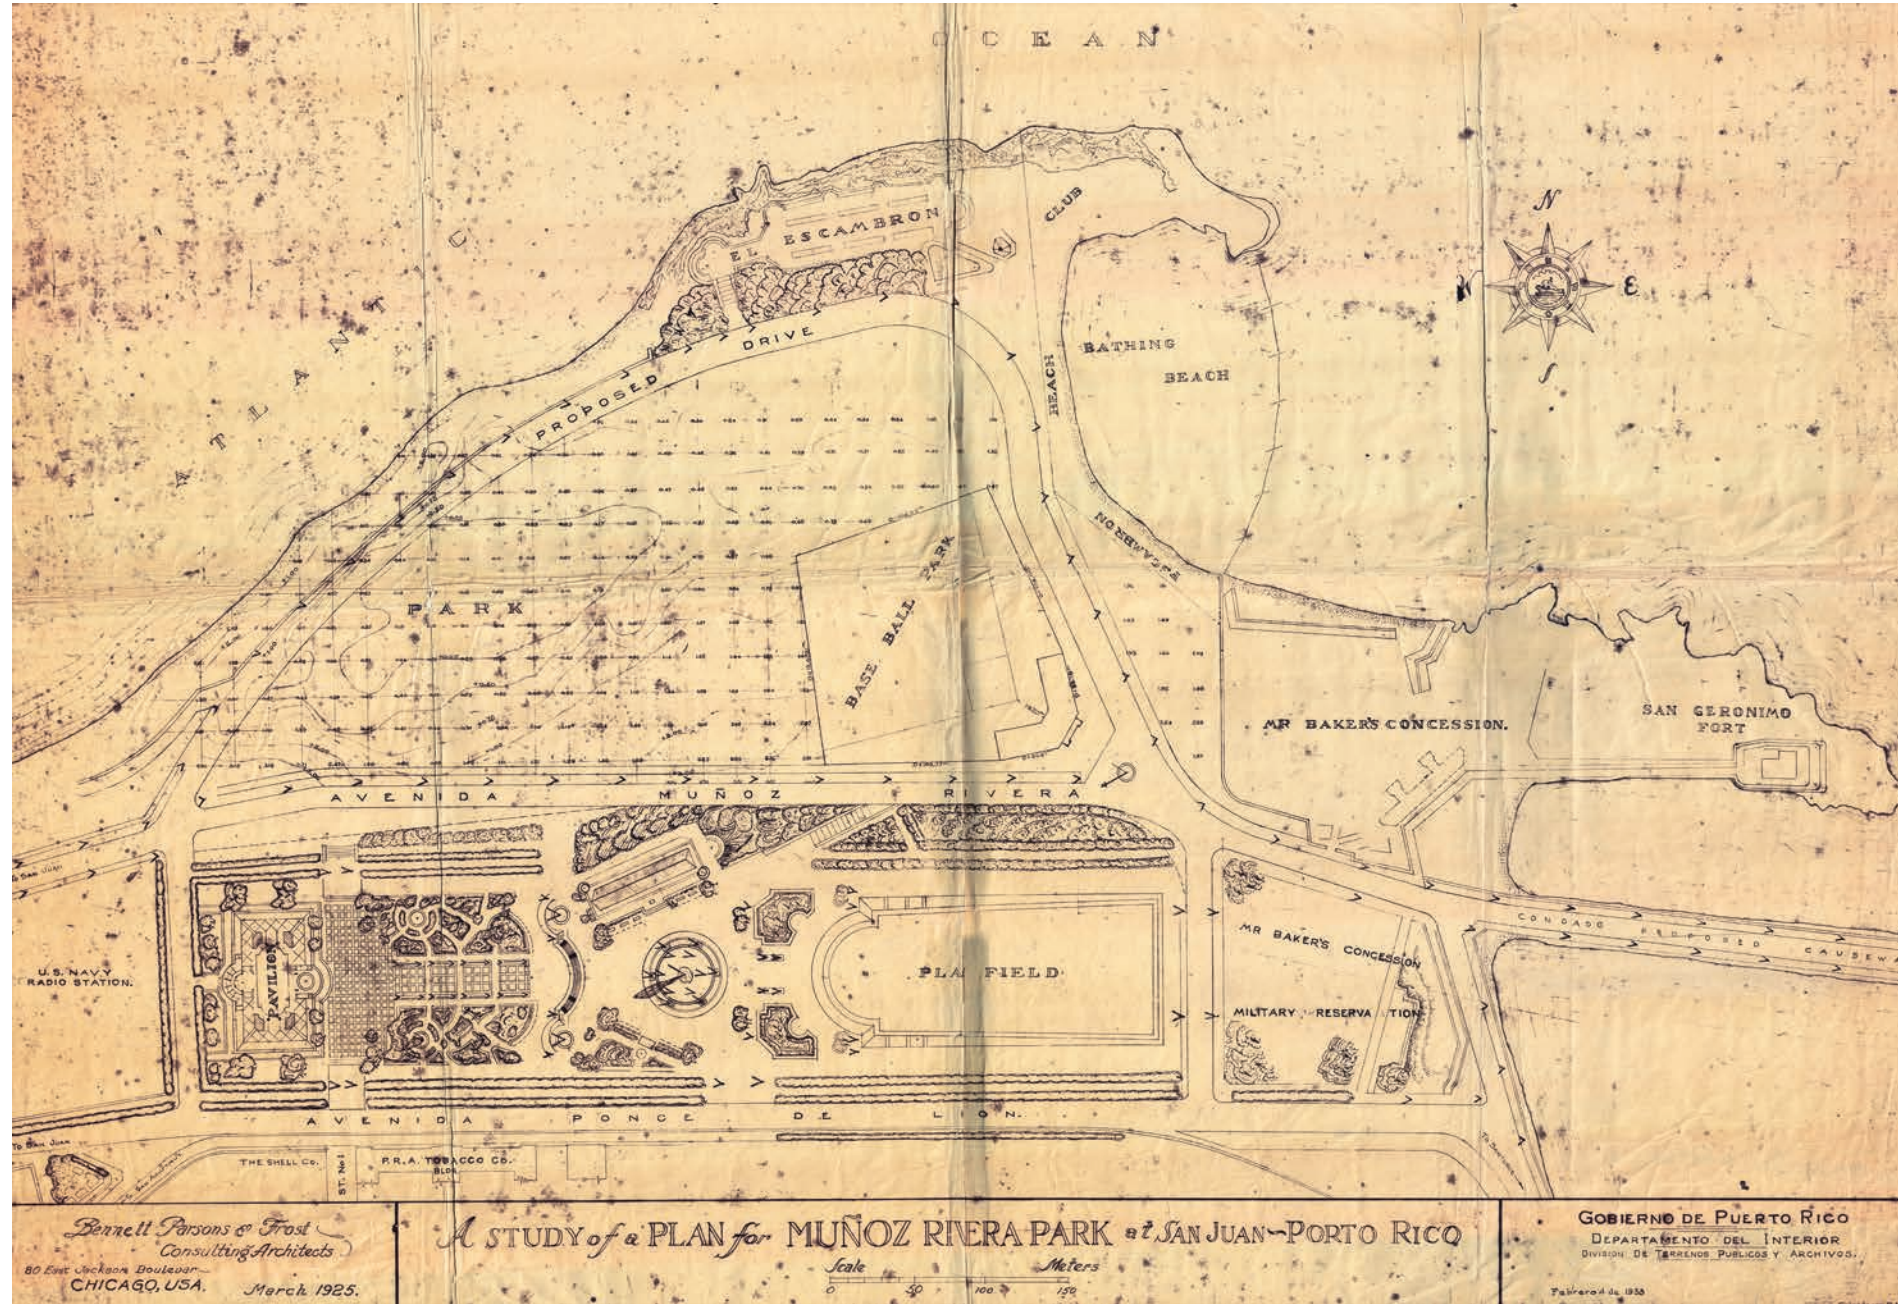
Segmento del plano *A Study of a Plan for Muñoz Rivera Park of San Juan, Puerto Rico*, marzo de 1925. Este plano fue preparado por la firma Bennet Parsons & Frost. Se puede observar la concesión de Baker, un puente proyectado al Condado (que no se construyó) y proyectos futuros: un parque de pelota (futuro Sixto Escobar), un pabellón (futuro Pabellón de la Paz) y el Escambrón Beach Club. Archivo General de Puerto Rico. AGPR. Cortesía de Joseph Harrison, Archivo Digital Nacional de Puerto Rico.
